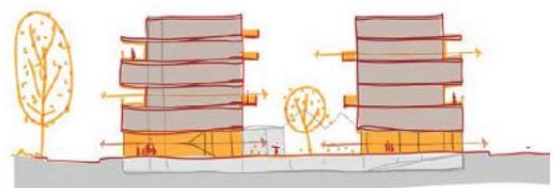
COUPE DE PRINCIPE DU PROJET
